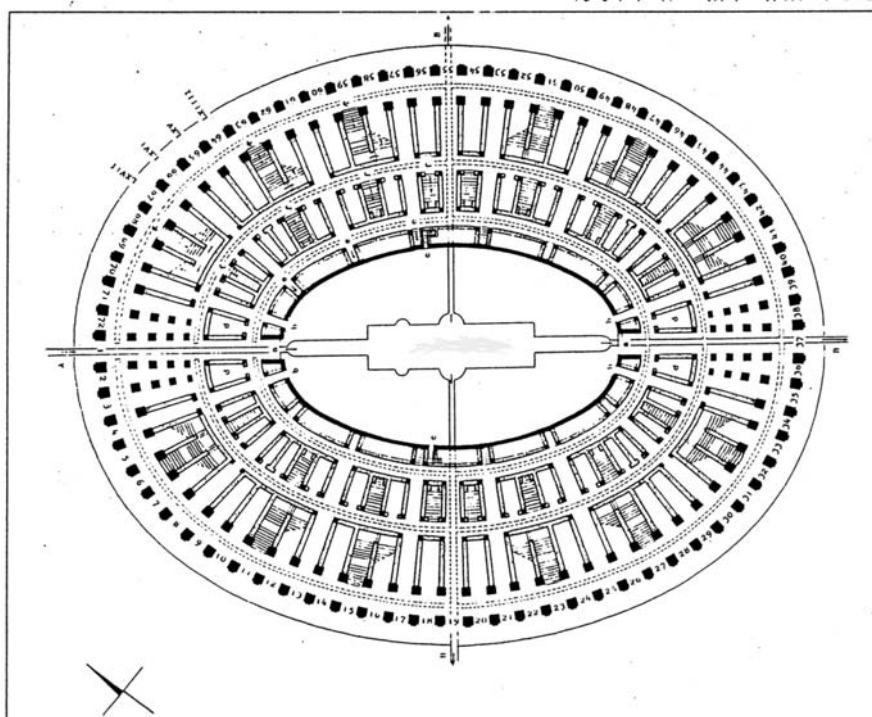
Planimetria dell'Arena (da GOLVIN 1988).
